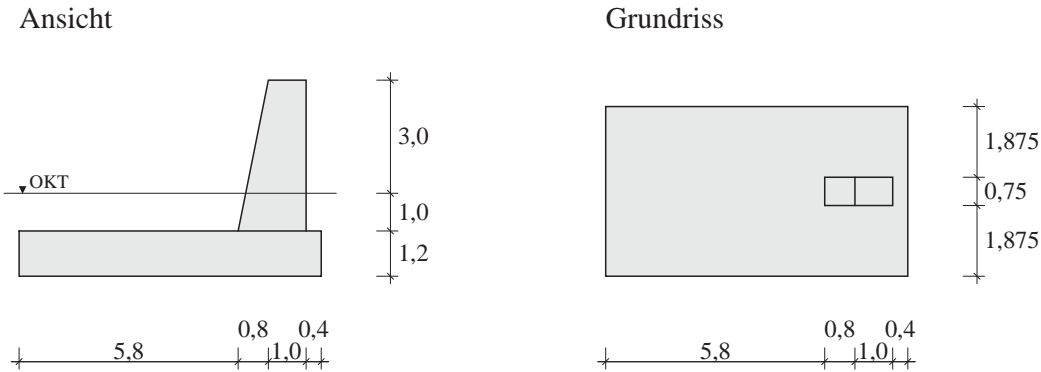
Ansicht und Grundriss der Verankerungskonstruktion, 1:200, Abmessungen in m.
